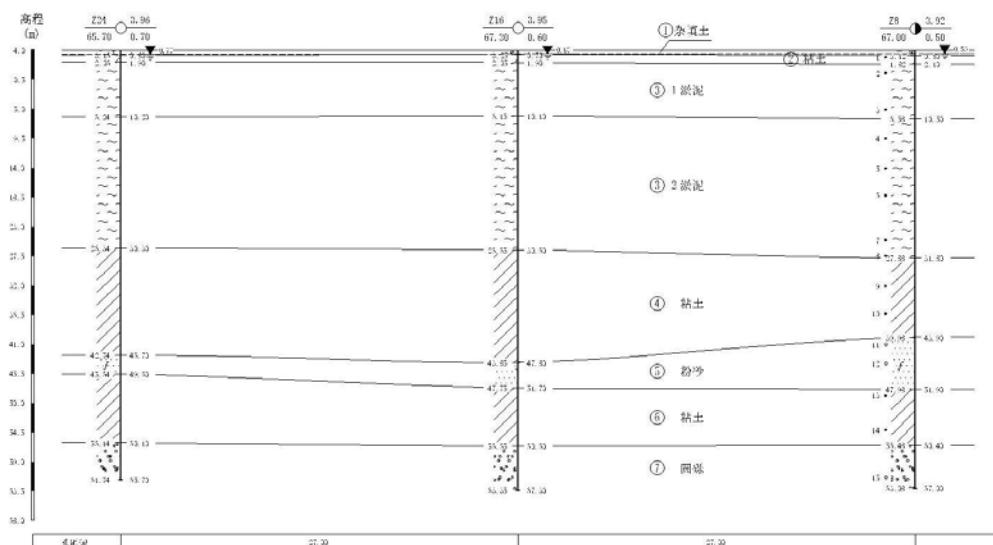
项目所在区域地层岩性 6-6' 典型剖面图
